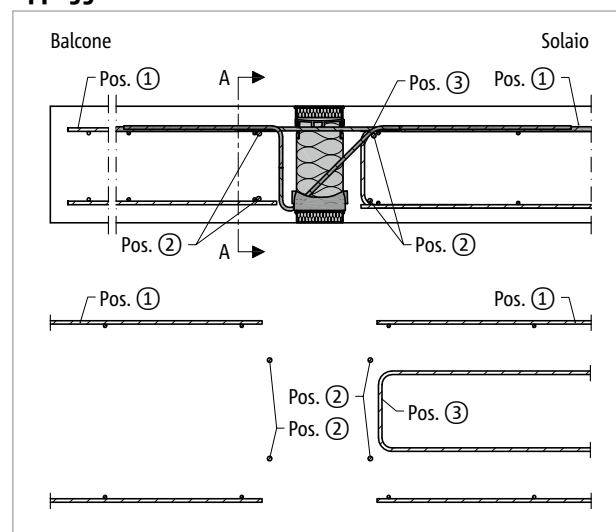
Schöck Isokorb® T tipo KL: armatura in opera con appoggio indiretto
